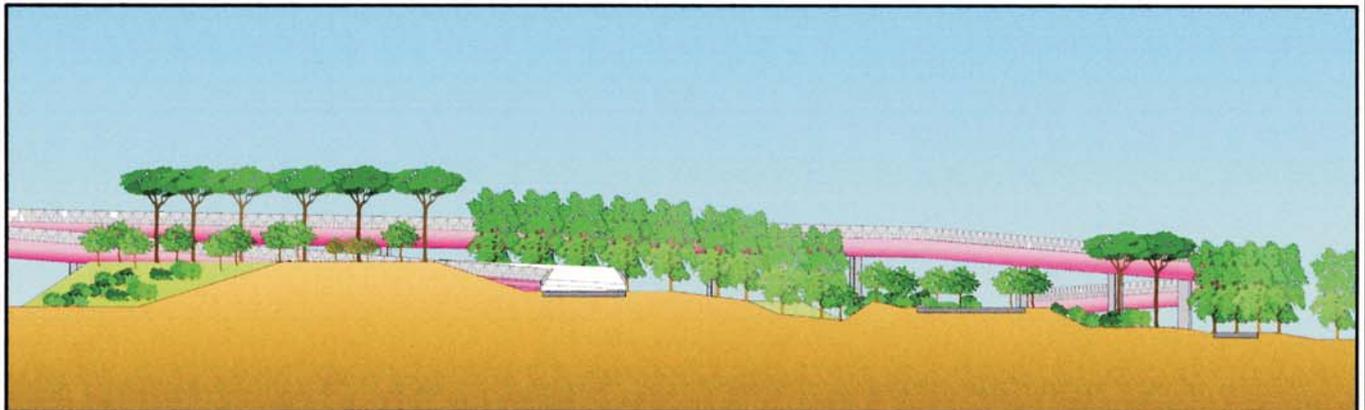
Svincolo di collegamento con la perimetrale di Scampia. Progetto. Planimetria
